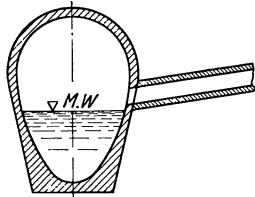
Einmündung einer Rohrleitung in einen gemauerten Kanal.
